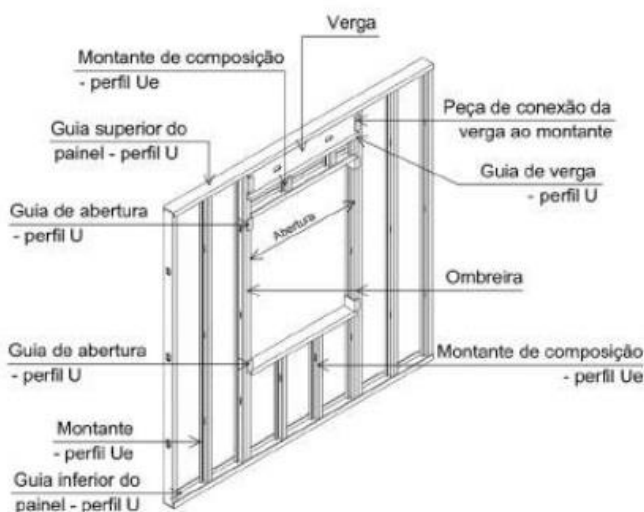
Elementos de uma estrutura em *Light Steel Frame*.
